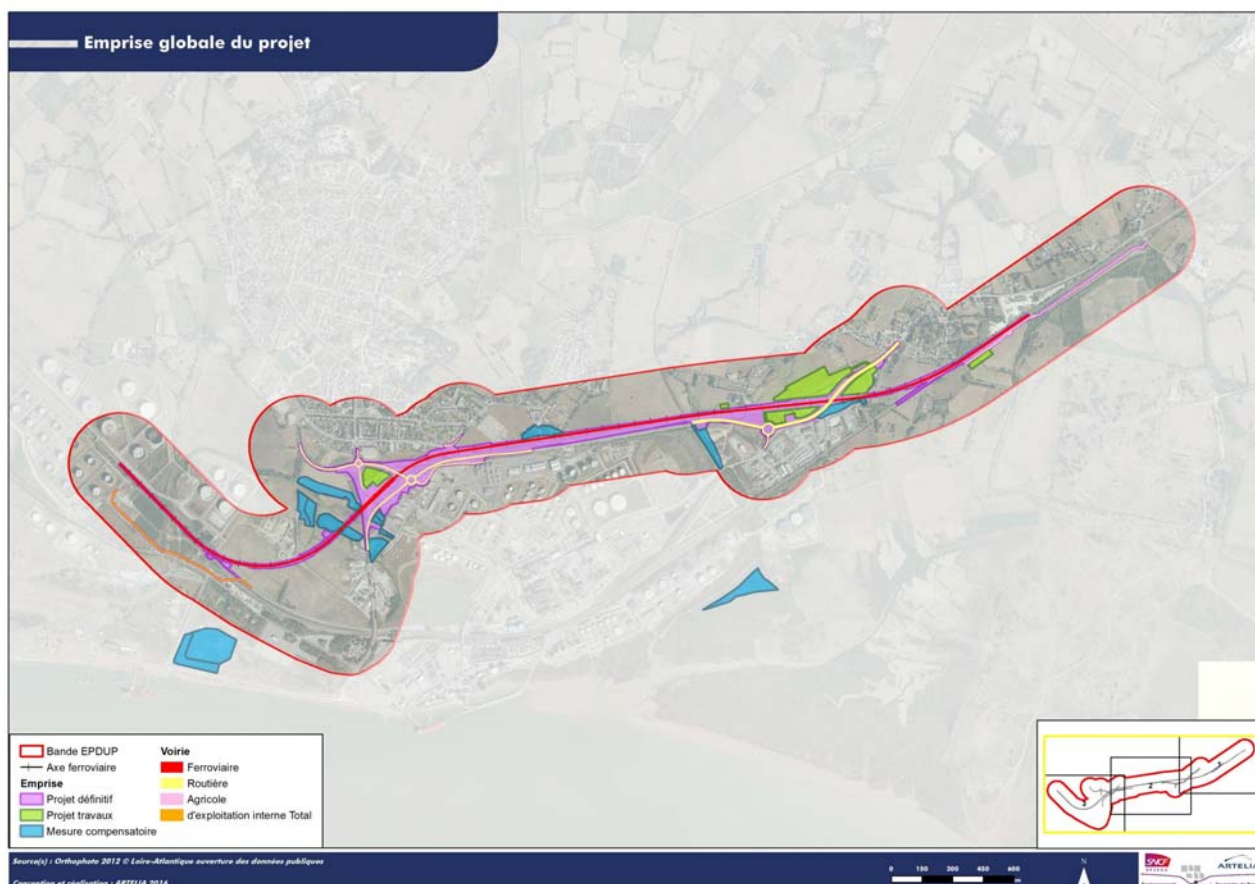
plan général des travaux (source : pièce C du dossier d'enquête publique). La halte ferroviaire envisagée est localisée juste au sud-est du giratoire le plus à l'ouest.
